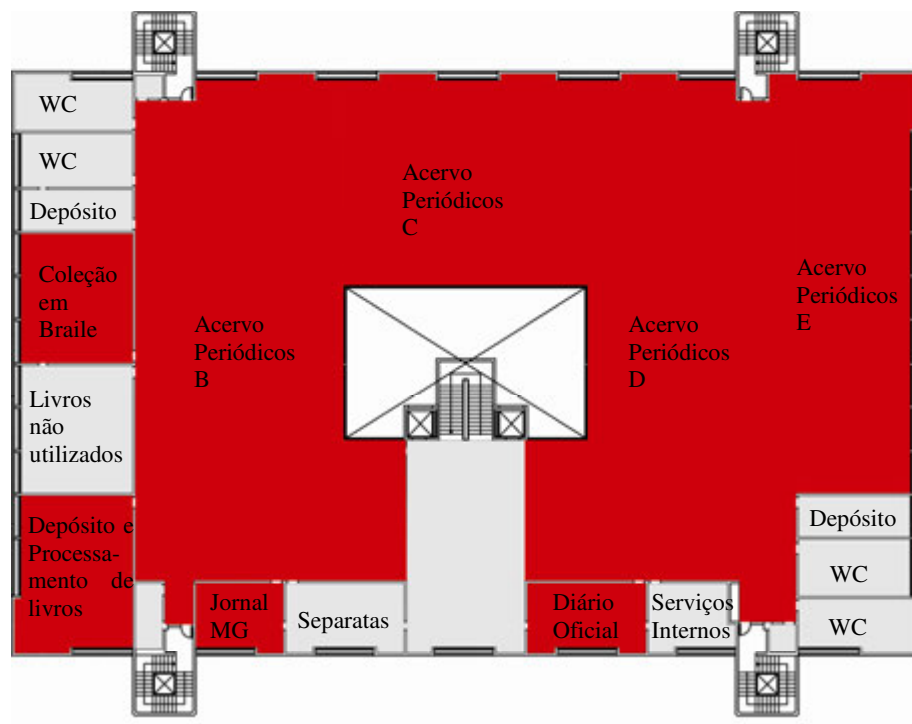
Planta baixa esquemática do terceiro pavimento.
